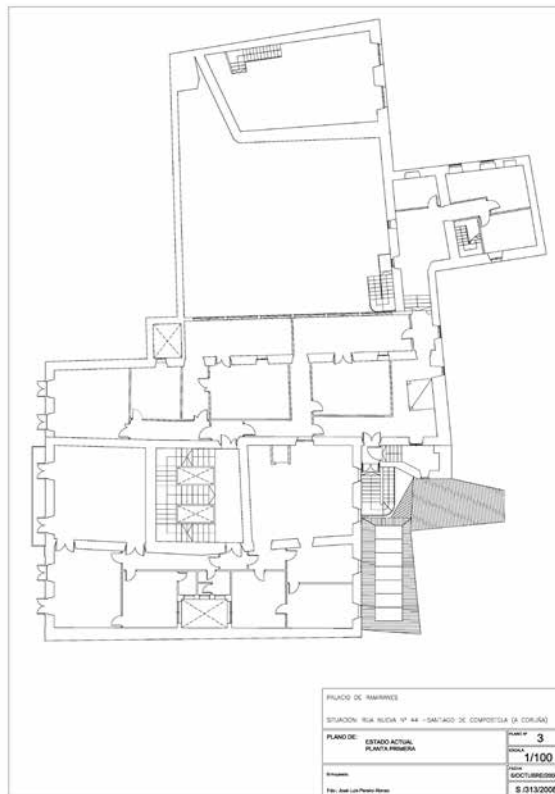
Primera planta de la casa. Estudio de arquitectura de José Luis Pereiro Alonso.
